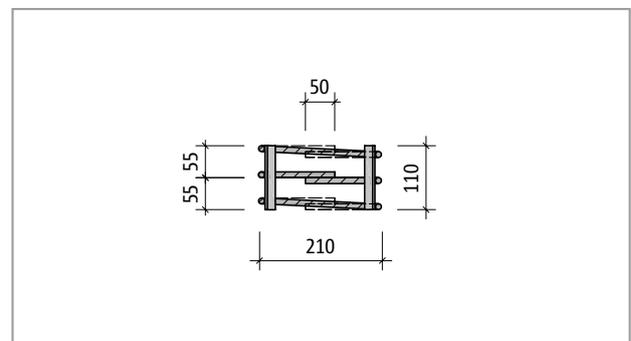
Schöck Sconnex® Typ P: Seitenansicht Part T; geschweißte Bügel und Biegeformsegmente aus Edelstahl
